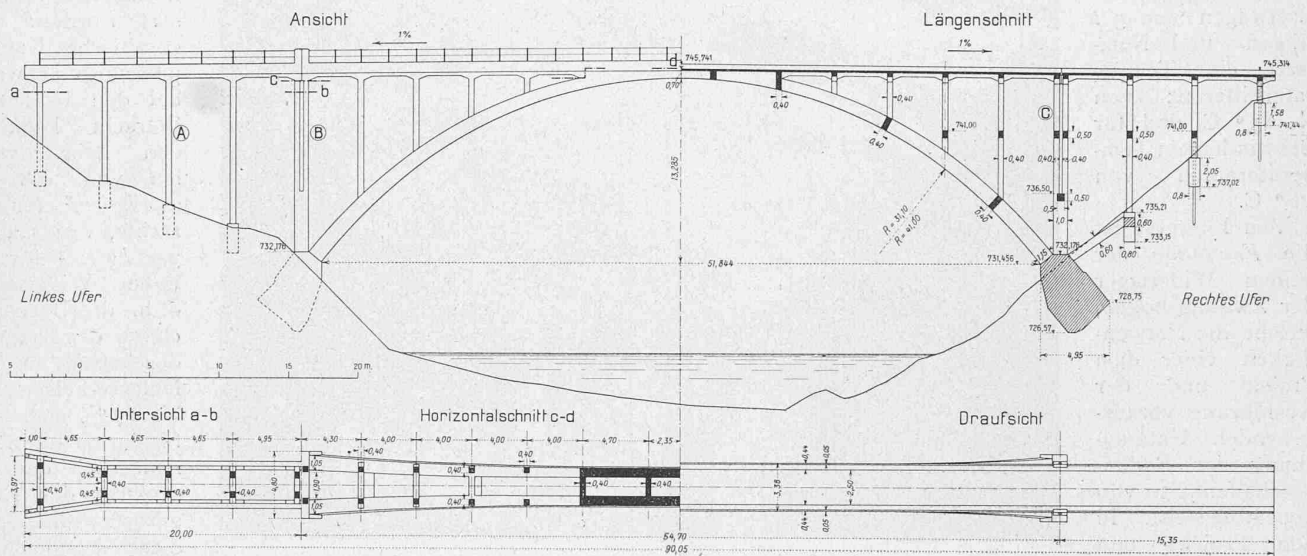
Ansicht, Vertikal- und Horizontal-Schnitte und Draufsicht der Scheeren-Brücke. — 1:500.
